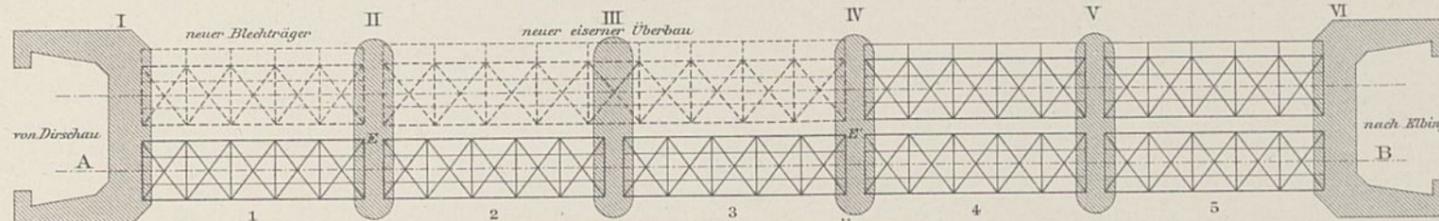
Grundriss der eisernen Überbauten.
